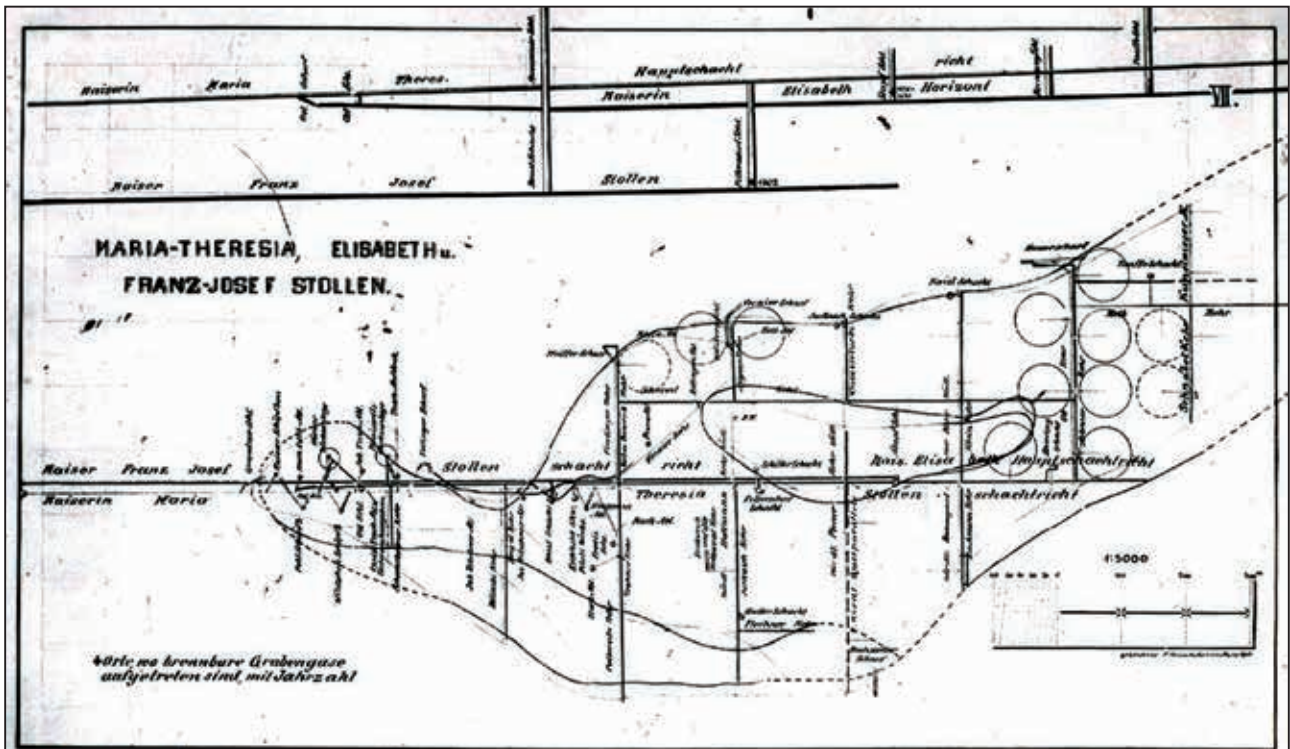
Schnitt durch den Salzbergbau Hallstatt; a) horizontal, b) vertikal
